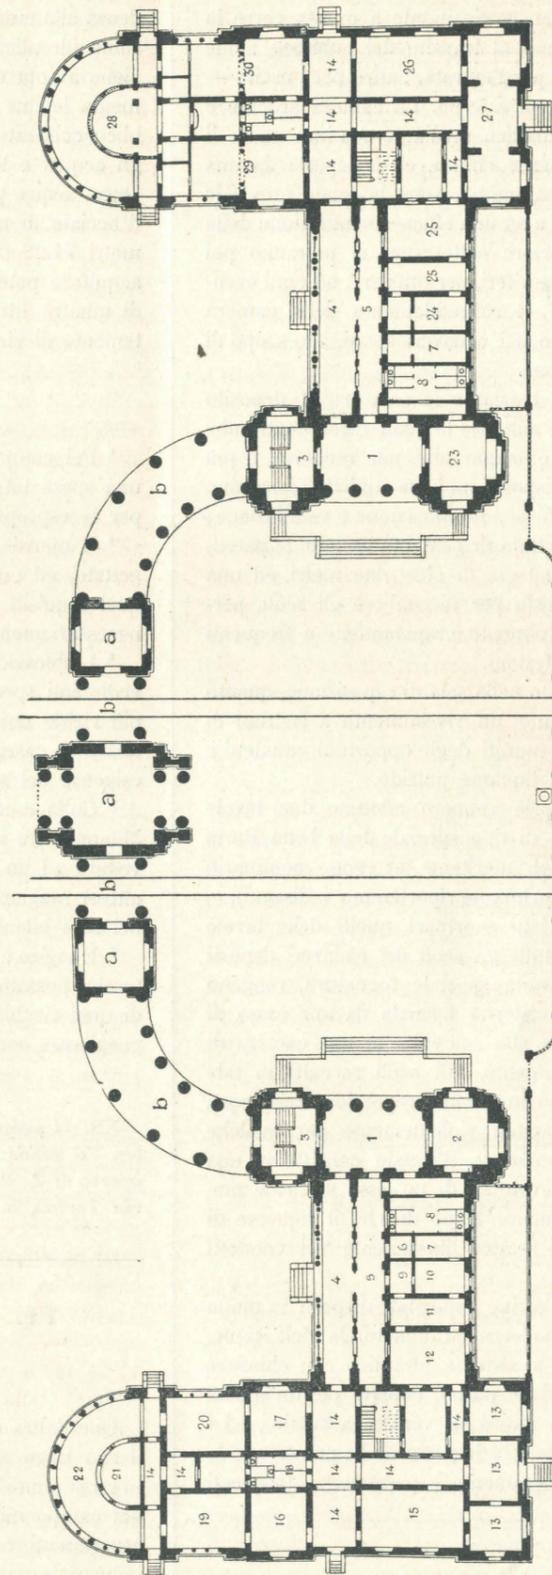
Pianta generale completa dell'edificio d'ingresso.
